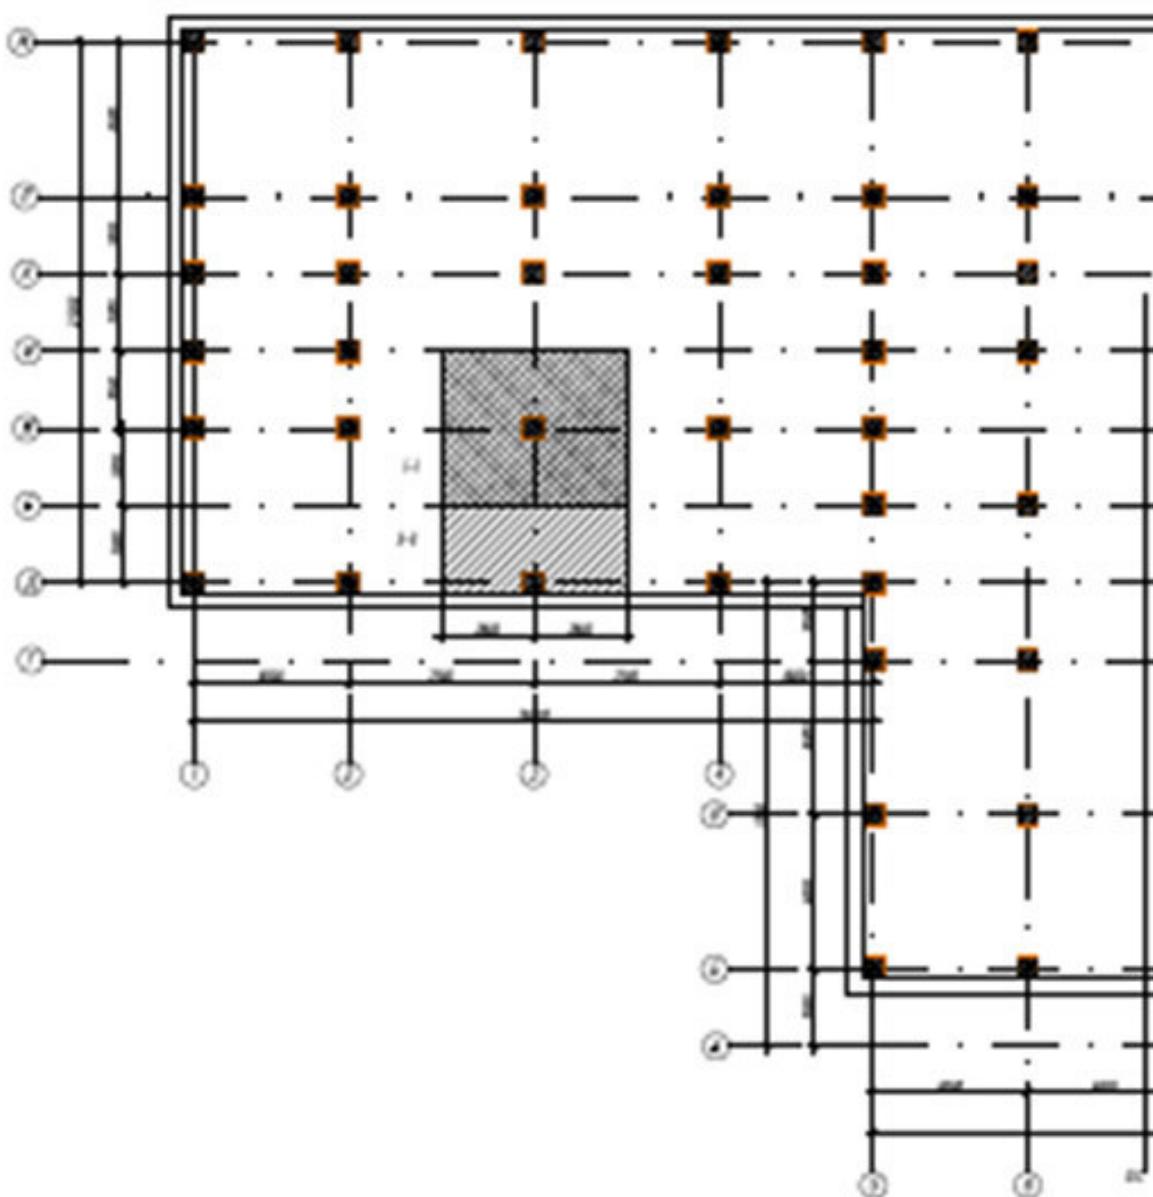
Фрагмент плана и грузовые площади для рассчитываемых фундаментов.
